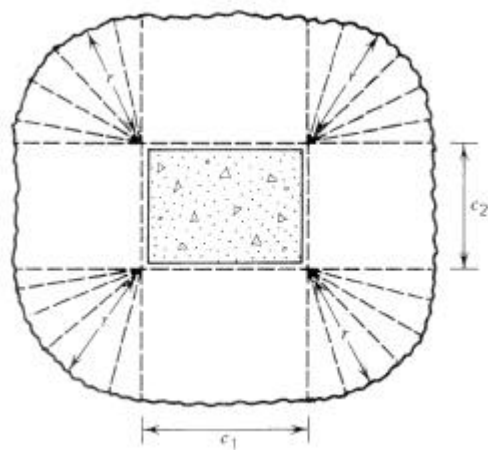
Placas sobre apoyos aislados con carga uniforme. Configuración de rotura local alrededor de columna rectangular.
